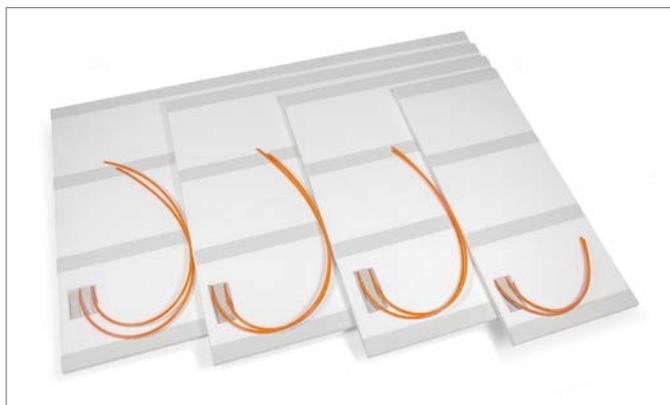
Système de chauffage / refroidissement par le plafond en construction sèche
